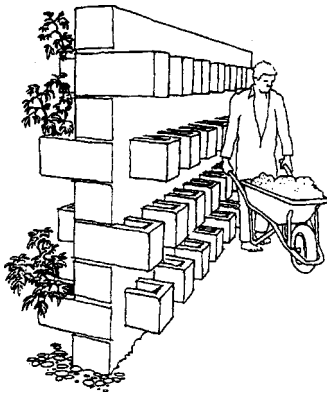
En Botswana, el Dr. Gus Nilsson ha desarrollado un sistema de producción hortícola intensivo para zonas tropicales secas, basado en paredes construidas con bloques prefabricados (también véase figura 5.3).
